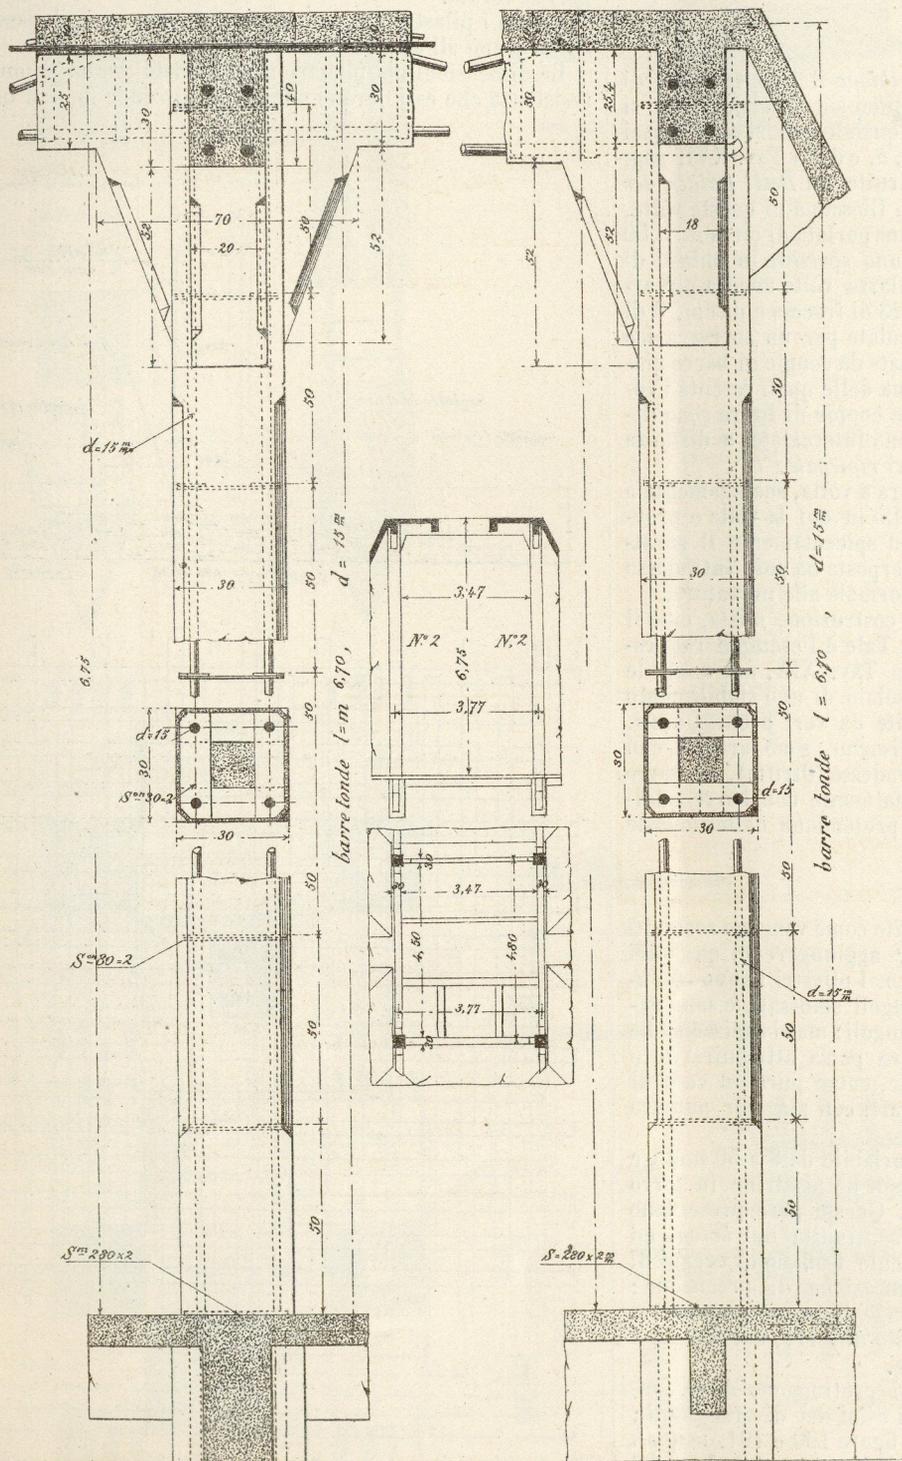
Pilastri in *béton* armato del Palazzo di Giustizia di Verviers. — Piano del sottotetto.
